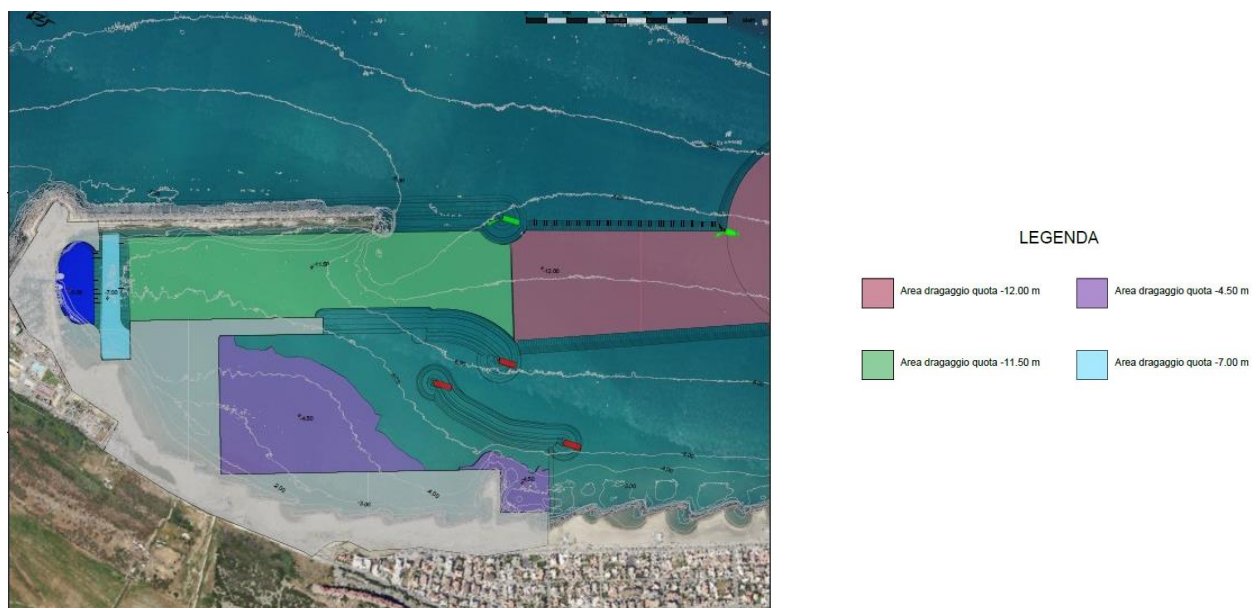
Planimetria dragaggi – riinterri di progetto
